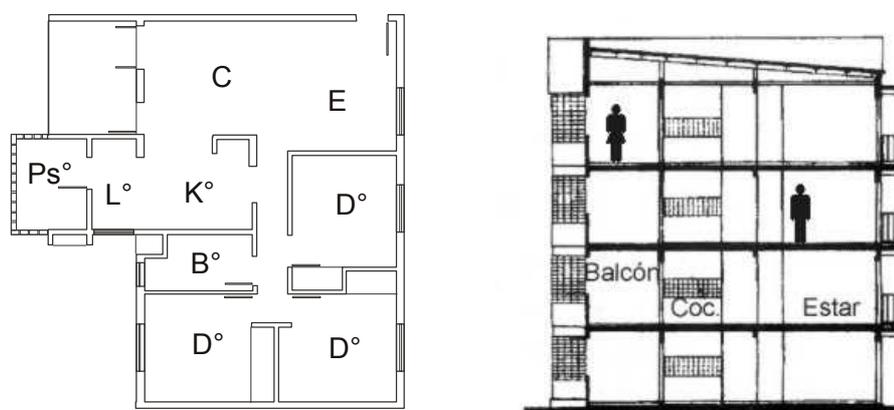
Planta y corte del prototipo de vivienda evaluada
